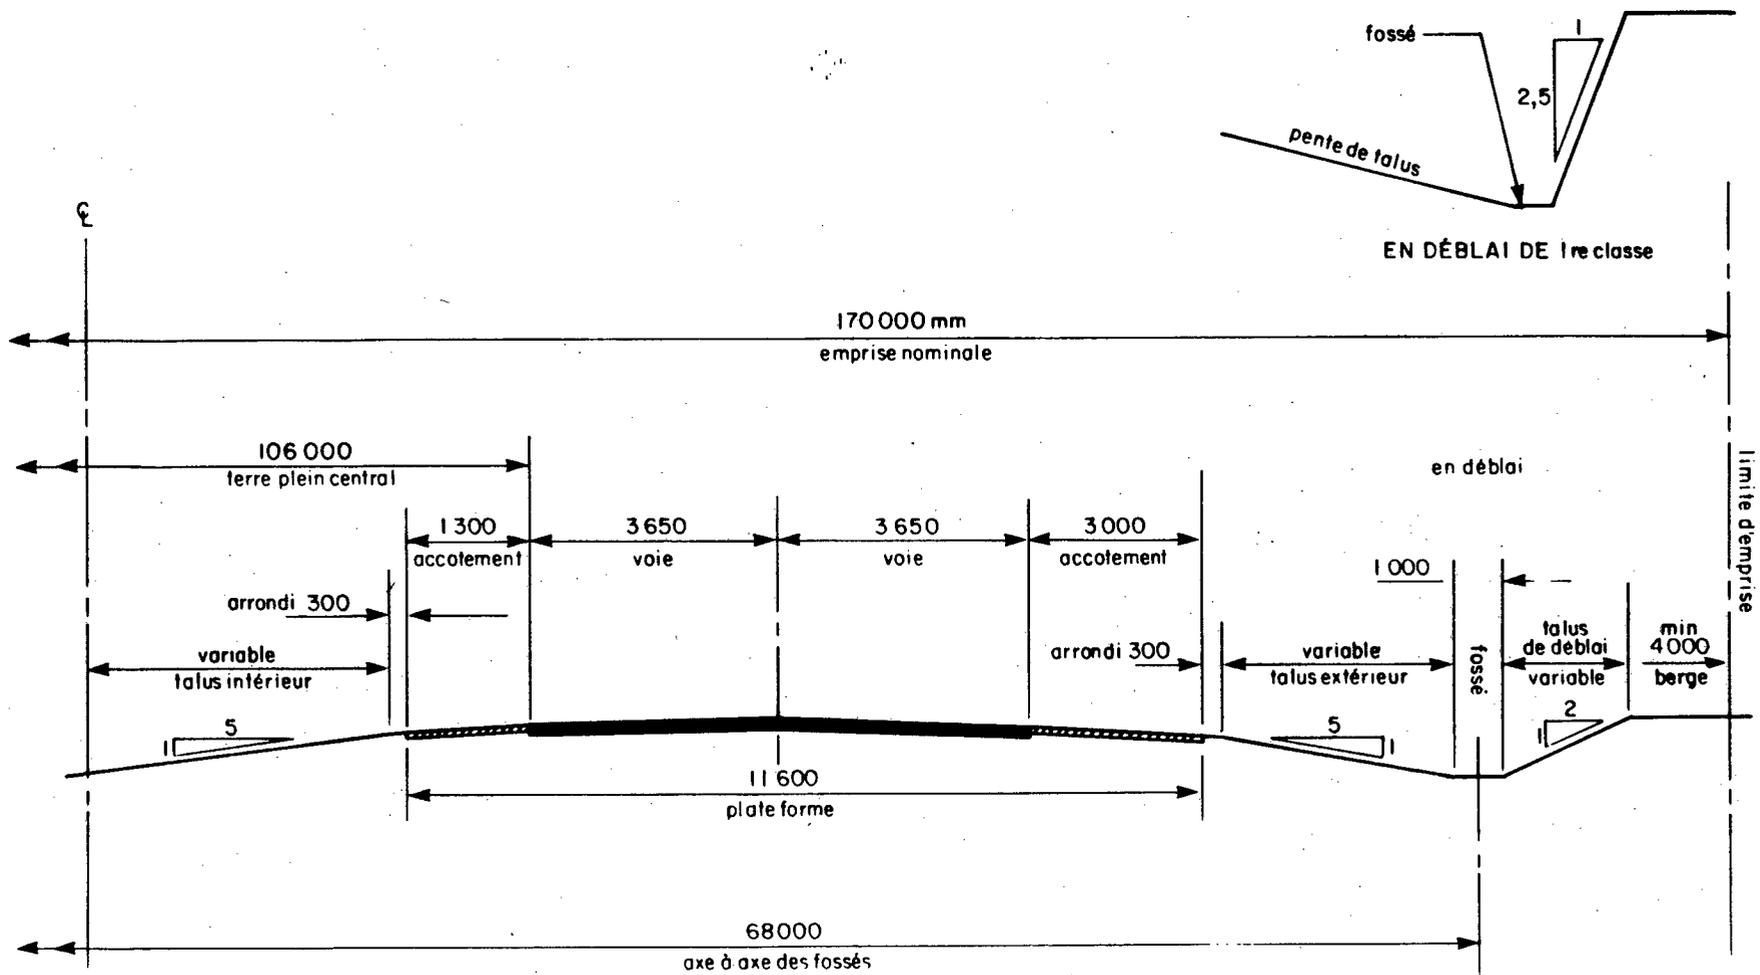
Profil en travers de l'autoroute à deux chaussées
